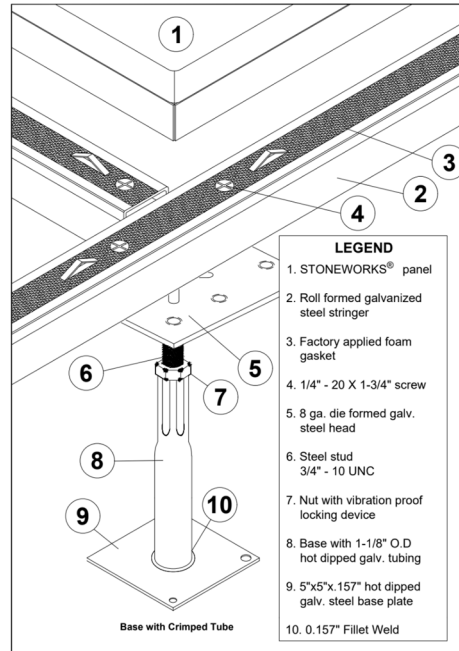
Extrait des dessins d'atelier du plancher surélevé (par Tate)
